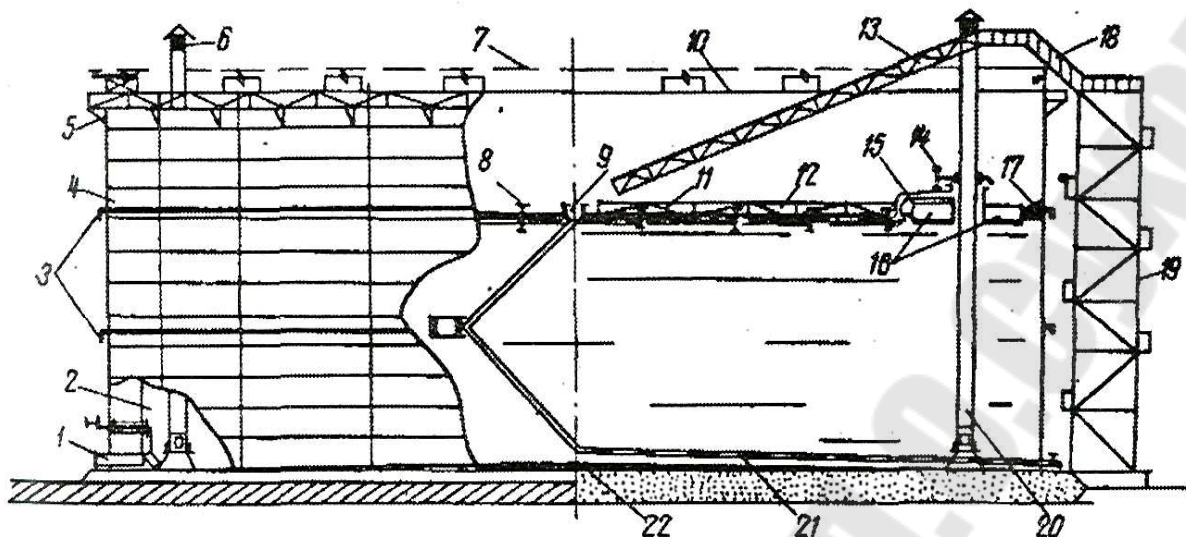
Резервуар с плавающей крышей: 1 - приемо-раздаточный патрубок с хлопущей; 2 - запасной трос хлопущей; 3 - кольца жесткости; 4 - стенка резервуара; 5 - кольцевая площадка жесткости; 6 - огневой предохранитель; 7 - трубопровод раствора пены; 8 - опорные стойки плавающей крыши; 9 - водоприемник атмосферных осадков; 10 — сухопровод орошения стенки резервуара; 11 - плавающая крыша; 12 - опорная ферма; 13 - катучая лестница; 14 - бортик удерживания пены; 15 - опорная ферма; 16 - периферийный кольцевой понтон плавающей крыши; 17 - уплотнитель (затвор) плавающей крыши; 18 - переходная площадка; 19 - шахтная лестница; 20 -трубчатая направляющая плавающей крыши; 21 - дренажная система; 22 - днище резервуара
